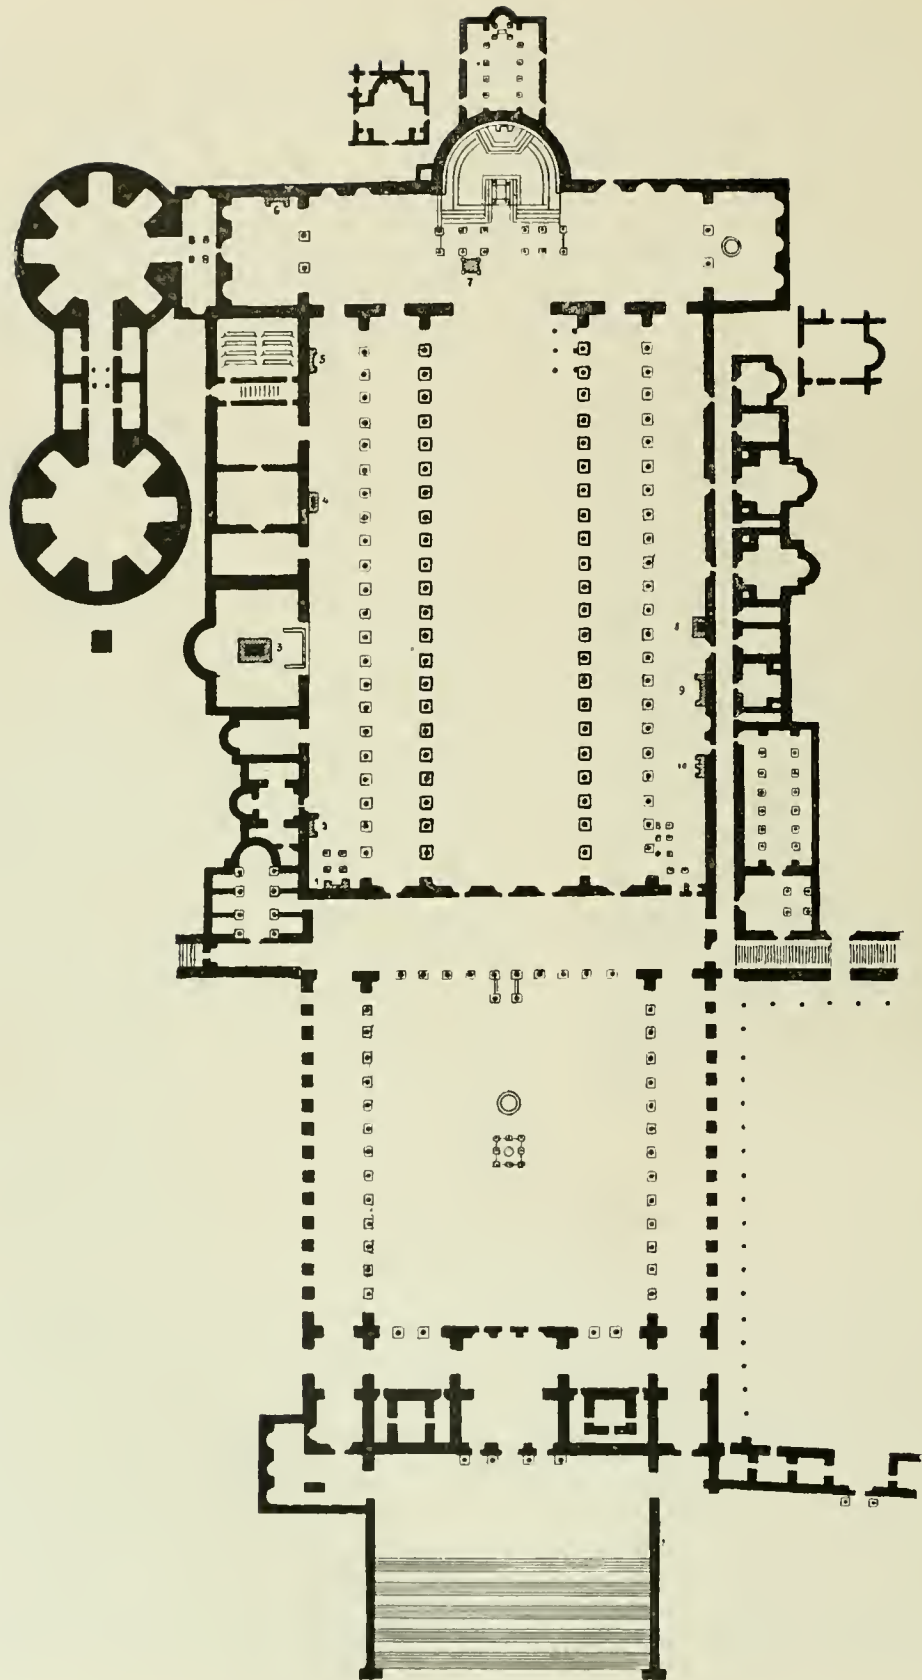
Grundriss von Alt-St. Peter nach Raphael Sindone.
